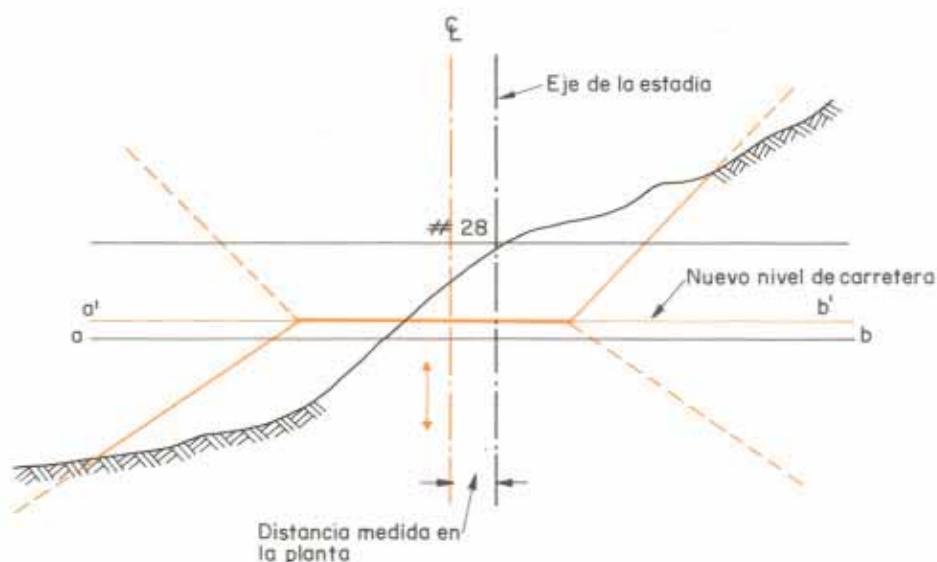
Fijación de la nueva rasante en una sección transversal.
